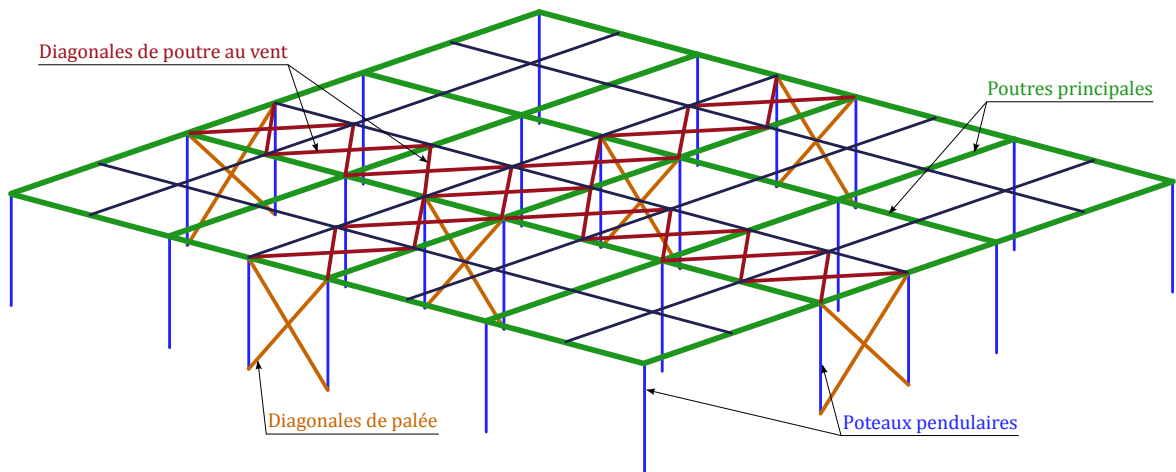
Réseau de poutres sur poteaux pendulaires (stabilisation par triangulation)
